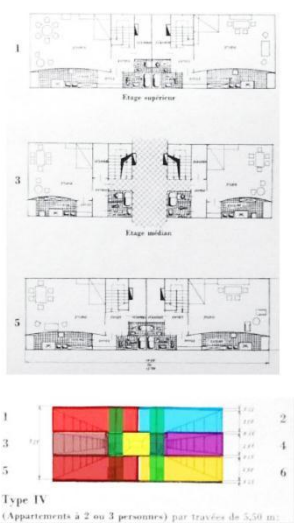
L'Ilot Insoluble*, planta do tipo 7, rua interior
